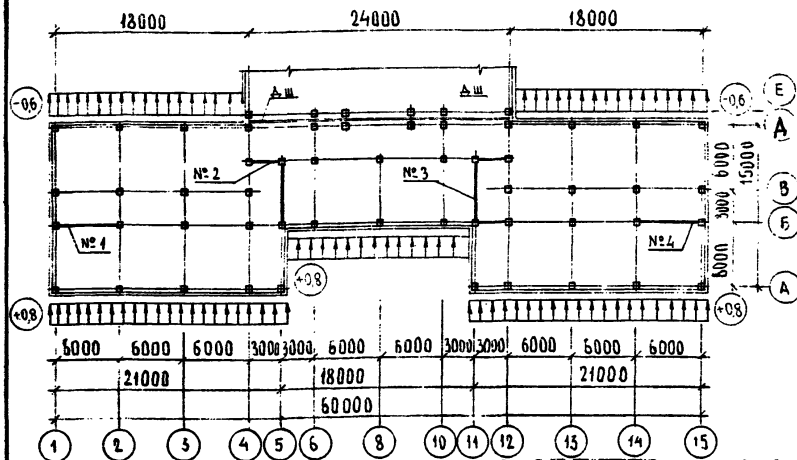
Схема приложения горизонтальной (ветровой) нагрузки вдоль цифровых осей здания (вариант II).
